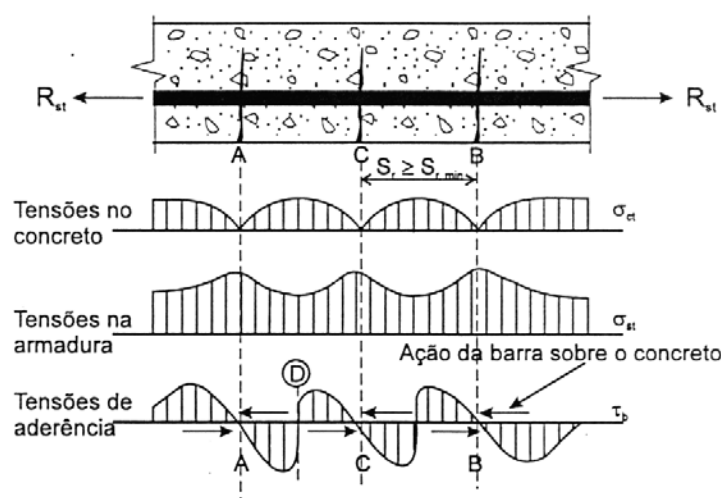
Tensões entre o aço e o concreto nas regiões fissuradas.
